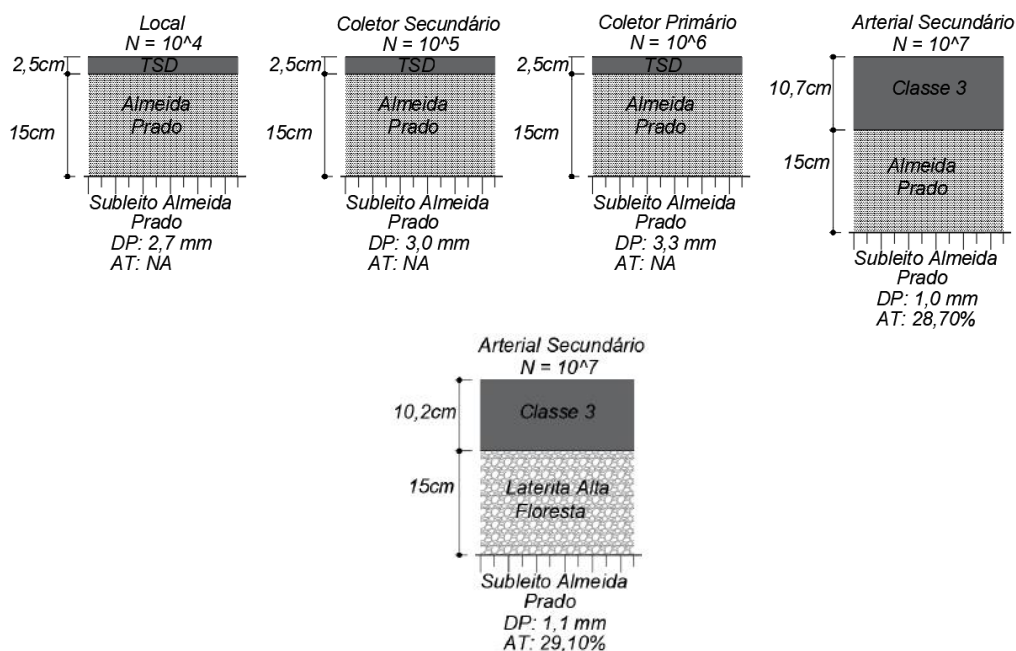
Estruturas de pavimentos propostas para solo Almeida Prado e Laterita Alta Floresta
